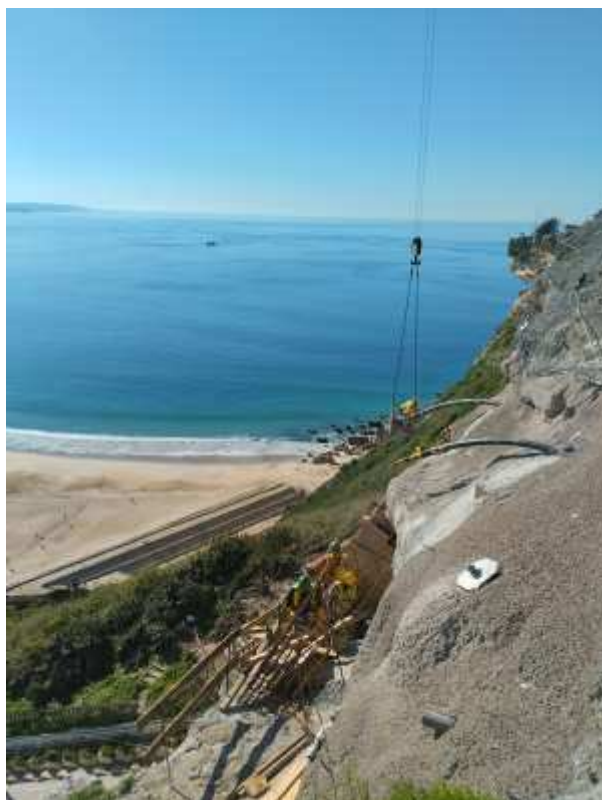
Cofragem de Montantes Verticais 1ª Fase
